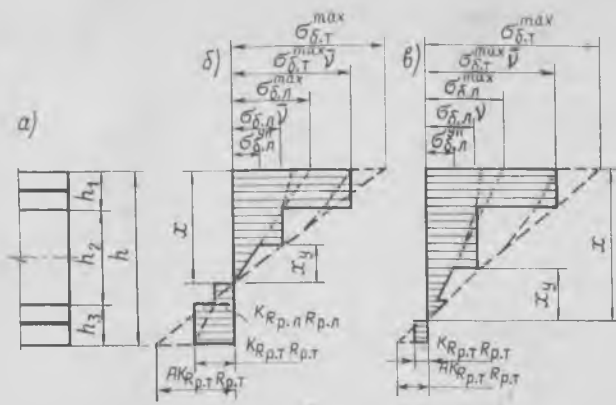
Напряженно-деформированное состояние трехслойного железобетонного элемента перед образованием трещин: а — схема элемента; б — приведенное сечение; в — эпюра деформаций
